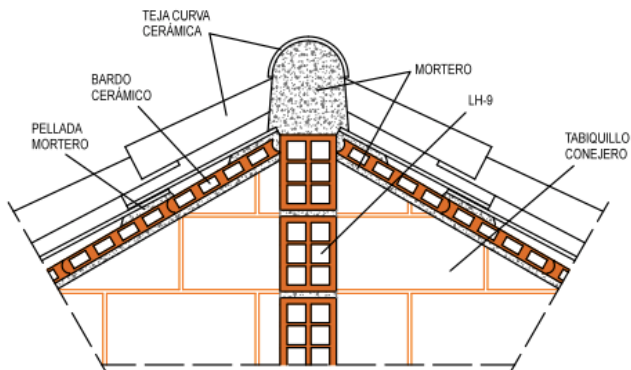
Sección cumbreira cubierta principal. Fuente propia.
